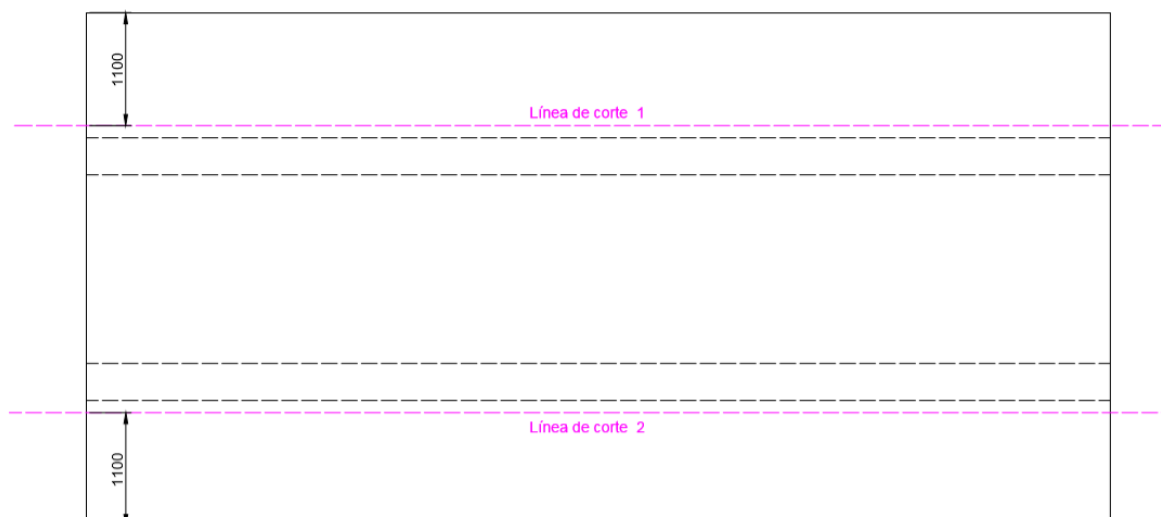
Sección longitudinal primera propuesta AutoCAD.
